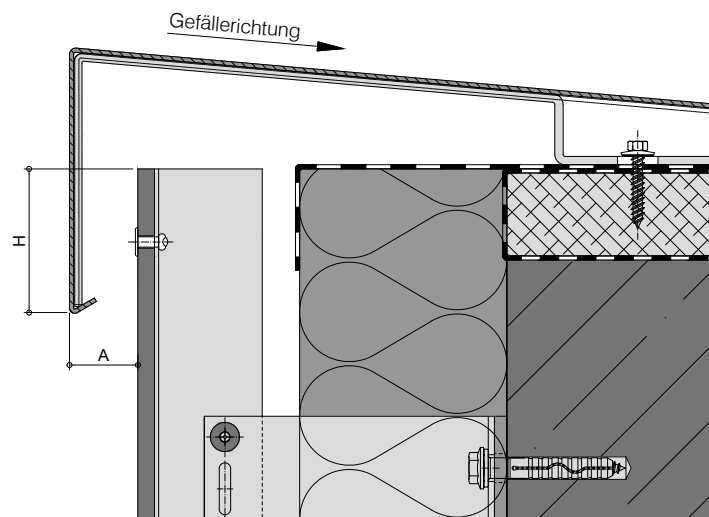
Übergang Fassade - Attika | Zeichnung: FVHF e.V.
